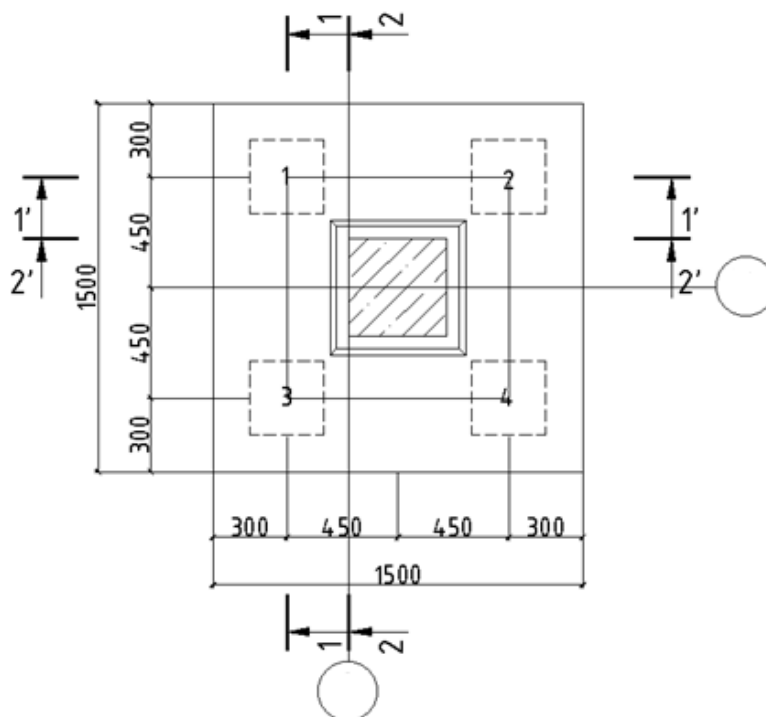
Схема эскизного конструирования ростверка свайного фундамента
